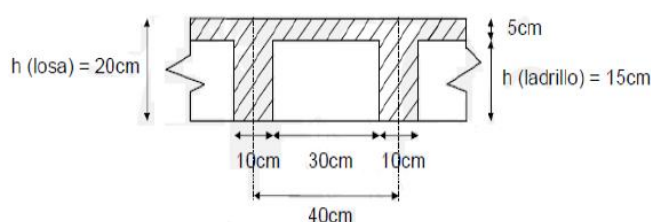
6 Sección de la losa aligerada en una dirección.
